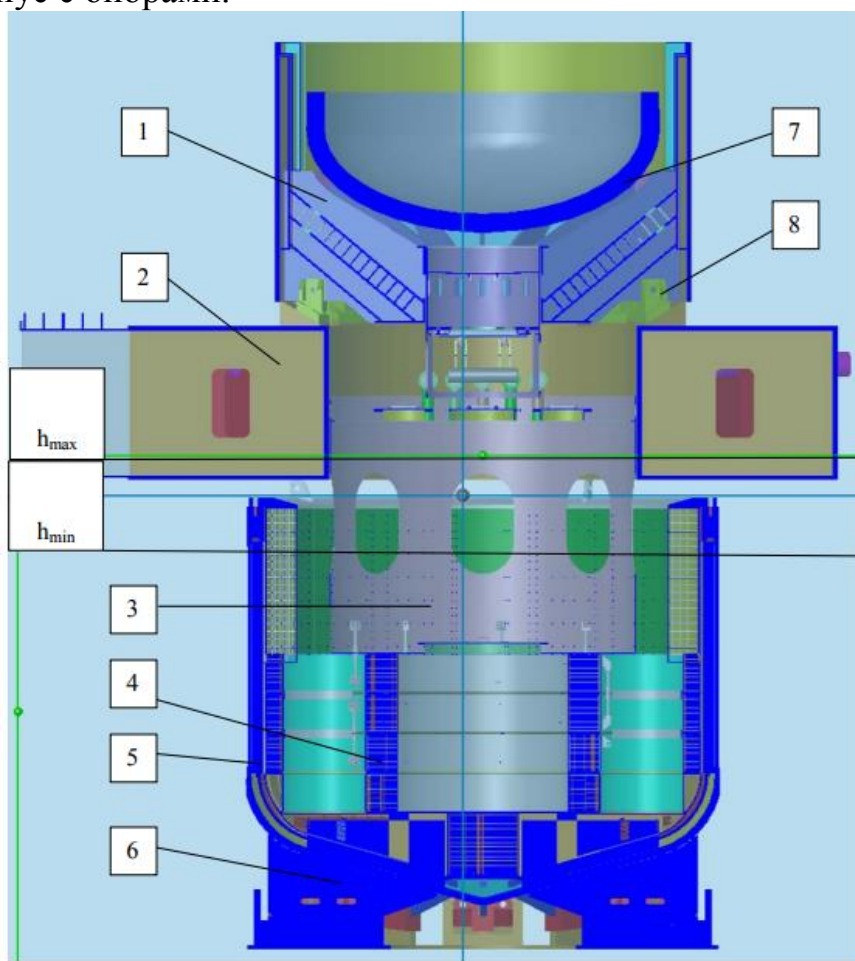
Внутреннее устройство УЛР: 1 - нижняя плита; 2 - ферма-консоль; 3 - площадка обслуживания; 4 – наполнитель; 5 – корпус УЛР; 6 - опора корпуса УЛР; 7 - корпус реактора; 8 - опора нижней плиты; h_{\max} – максимальный уровень воды; h_{\min} – минимальный уровень воды
